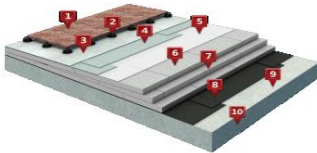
Система експлуатованого даху під пішохідне навантаження з пластиковими опорами: 1 – тротуарна плитка; 2 – пластикові опори; 3 – голкопробивний теплообробний геотекстиль; 4 – полімерна мембрана; 5 – розділовий шар – стеклохолст; 6 – клиновидні плити; 7 – екструзійний пінополістирол; 8 – бікроеласт ТПП; 9 – цементно-піщана стяжка; 10 – залізобетонна підстава
